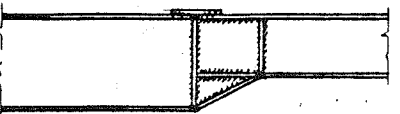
Detalles constructivos en estructuras soldadas
